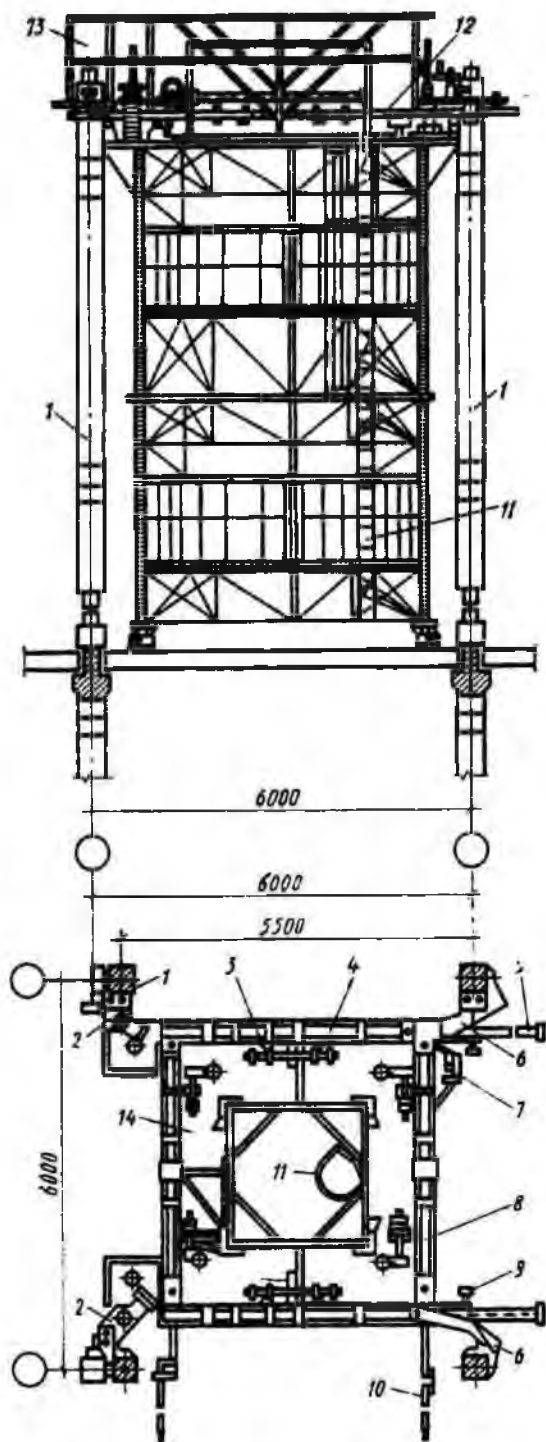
Схема рамно-шарнирного индикатора (РШИ) для установки двух-этажных колонн:
